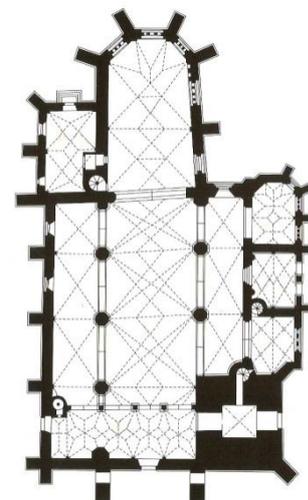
Bardejov, Ägidiuskirche, Grundriss, 1415-87
